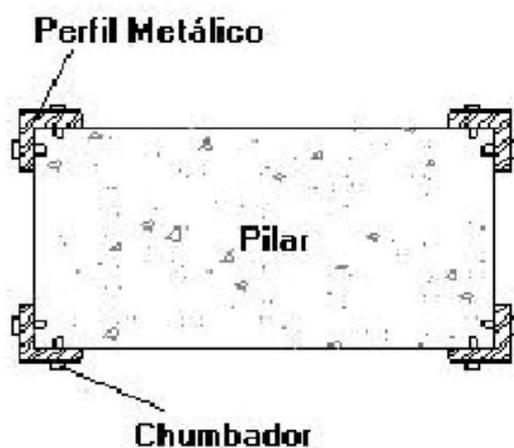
Reforço utilizando cantoneiras metálicas (Rigazzo, 2003).
